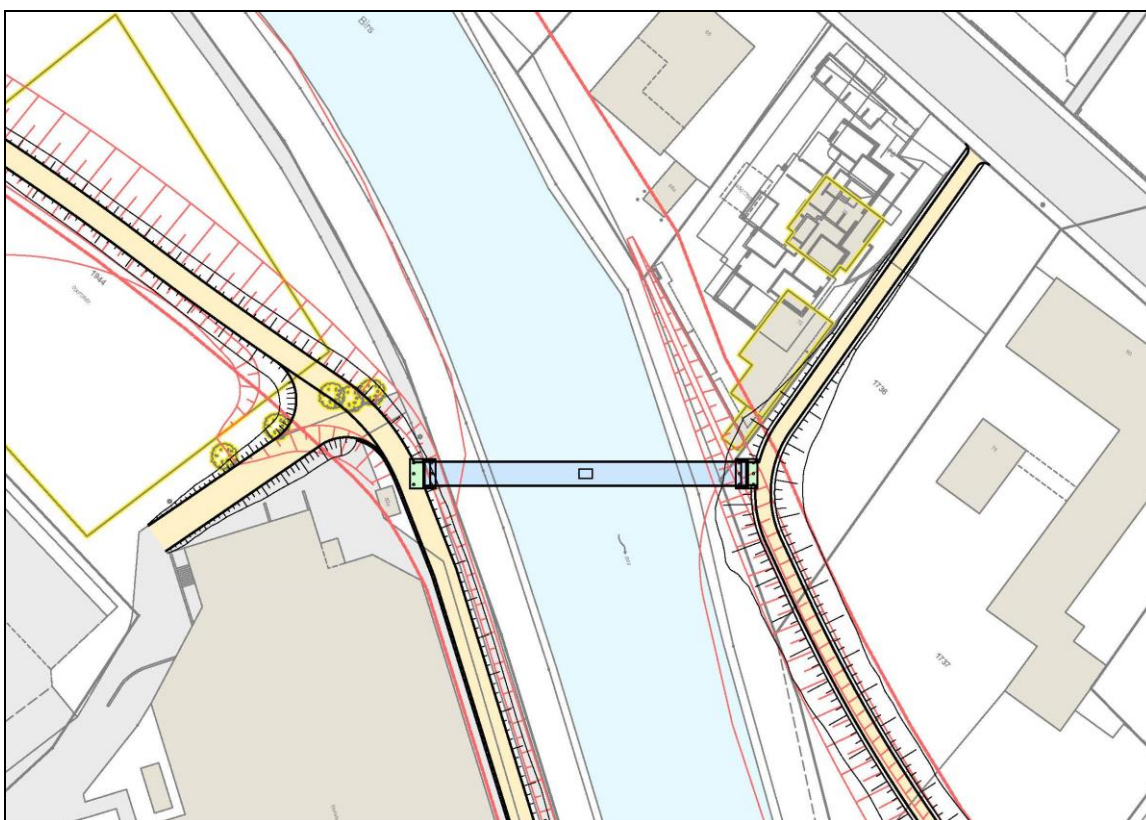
Gelb: geplante Fussgängerzugänge
